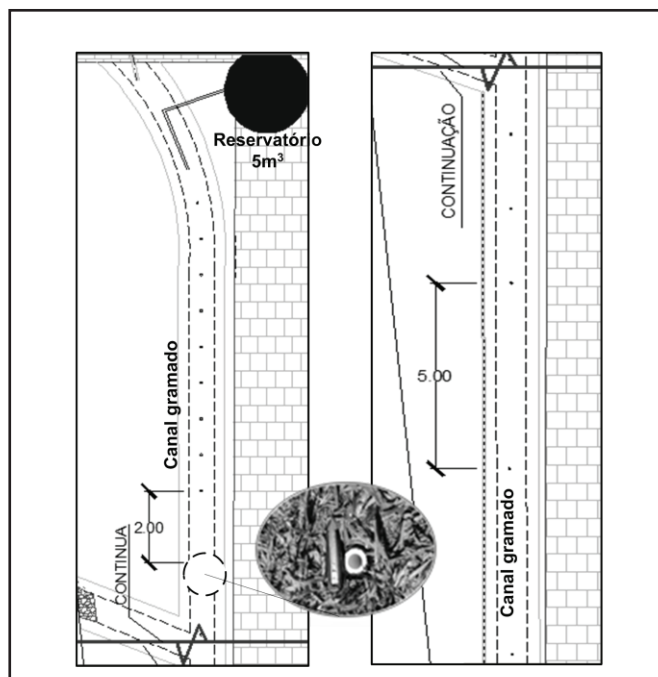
Vista seccionada em planta do canal gramado com indicação do reservatório para descarregamento e dos coletores espaçados ao longo do comprimento do canal. A vista foi seccionada na posição indicada, para facilitar visualização. Em detalhe fotografia do coletor ao lado de um objeto de 12 cm sem escala
